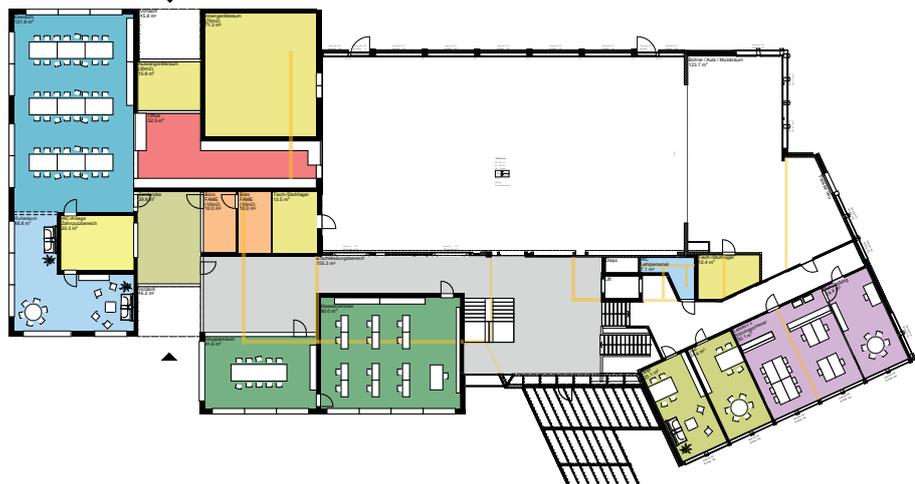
EG Grobdispo - Variante 2, 26.3.25 (Hinweis: Vergrößerung siehe Planbeilage)
